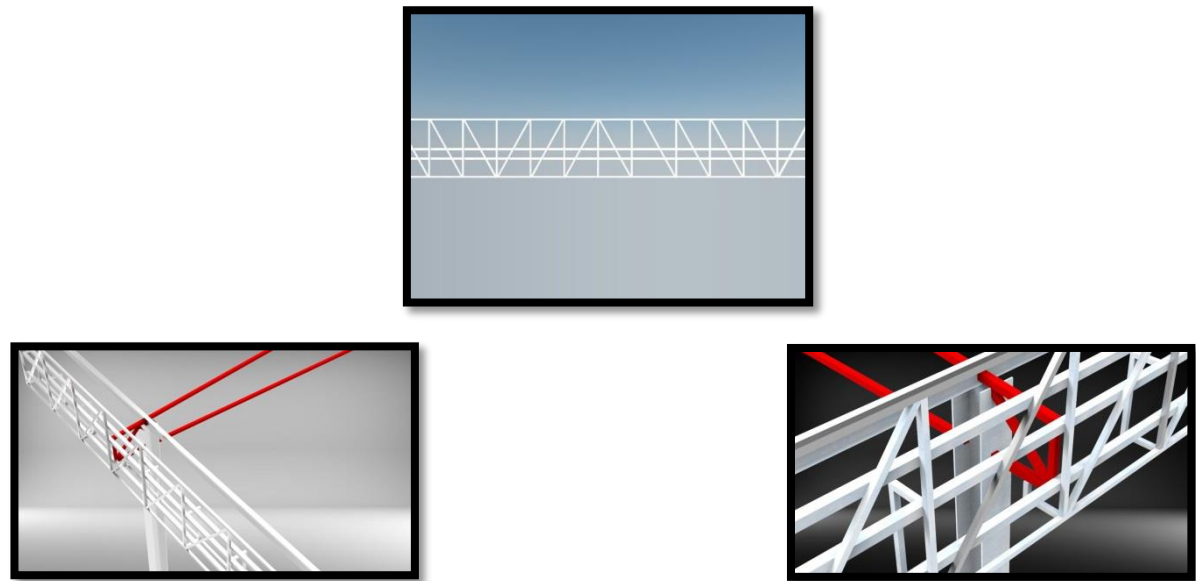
Lamina elevación arquitectónica con fascia estructural
